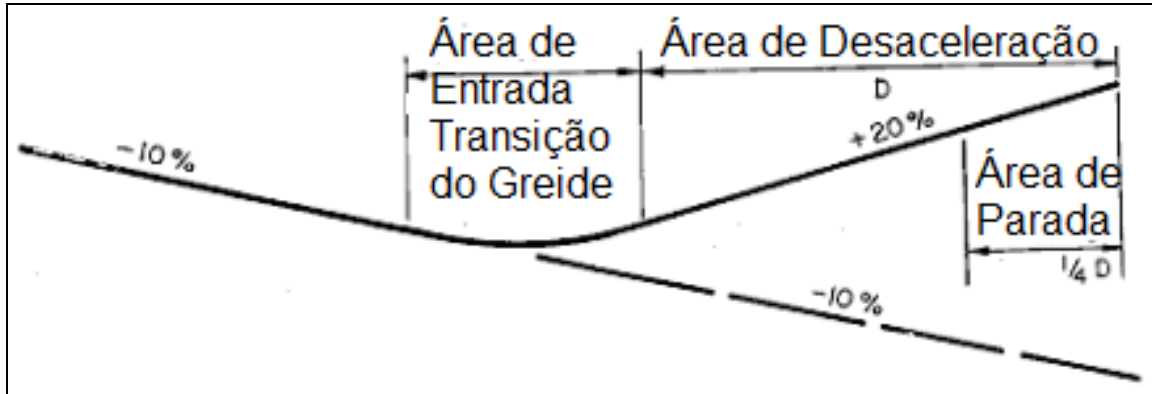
Estrada de Mina - Perfil - Rampa de Escape Áreas: Entrada, Desaceleração e Parada.
